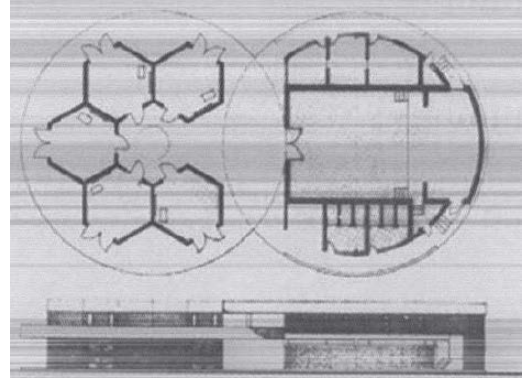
Raşad Şehri, Okulun Zemin kat planı ve cephesi.
